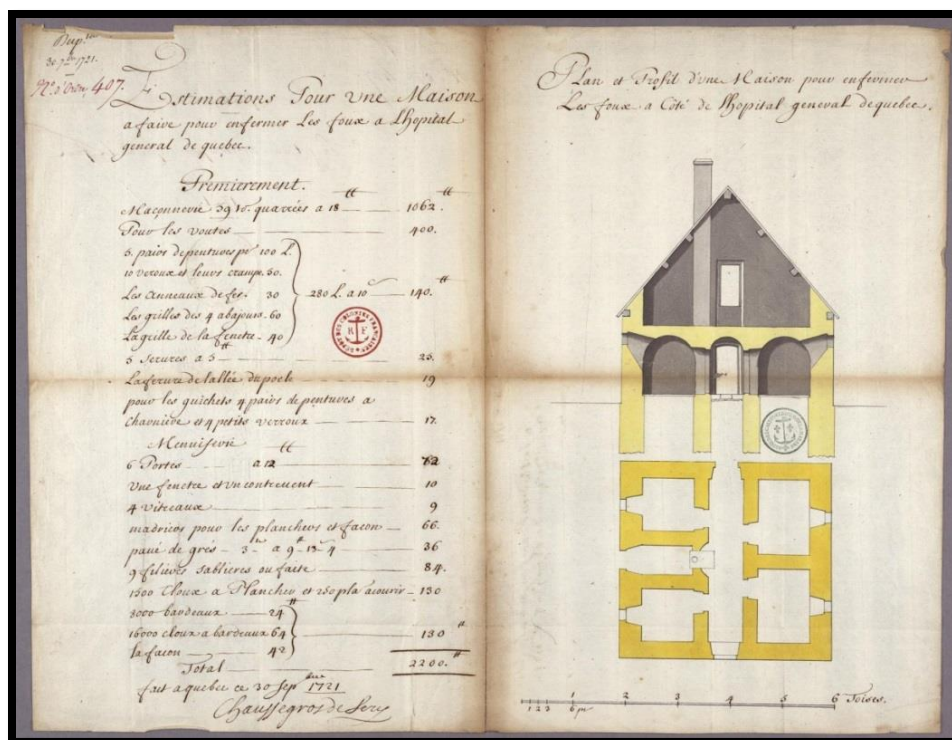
Plan du nouveau bâtiment des loges. « Plan et Profil d'une Maison pour enfermer les foux à Côté de l'Hopital général de quebec » par Chaussegros de Léry, 1721. Archives nationales d'outre-mer, FR ANOM.
